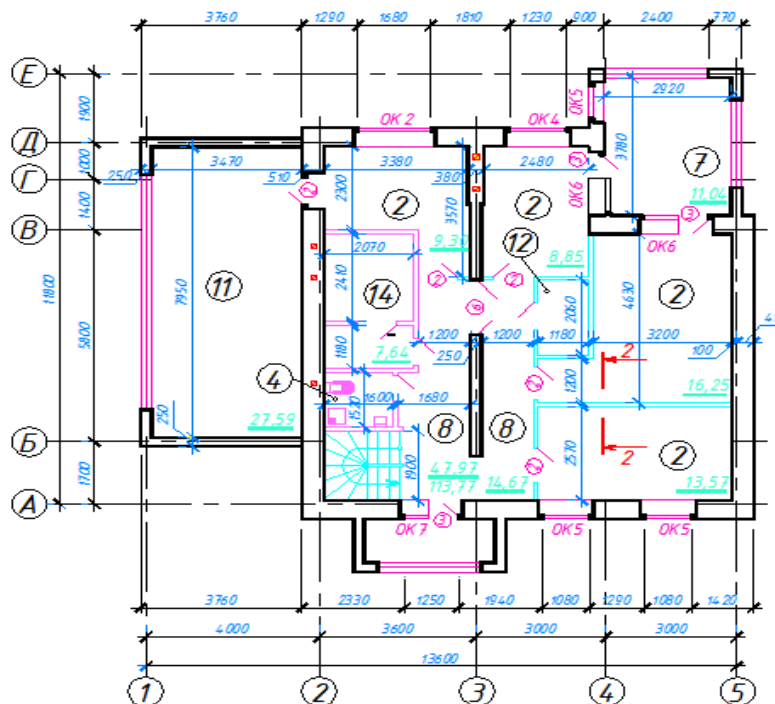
План першого поверху на відмітці +3,600 м
